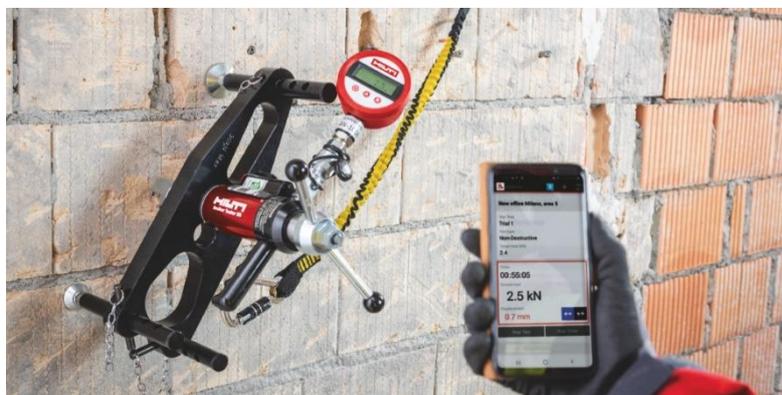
Máquina de ensayo directo. (Hilti.com)
